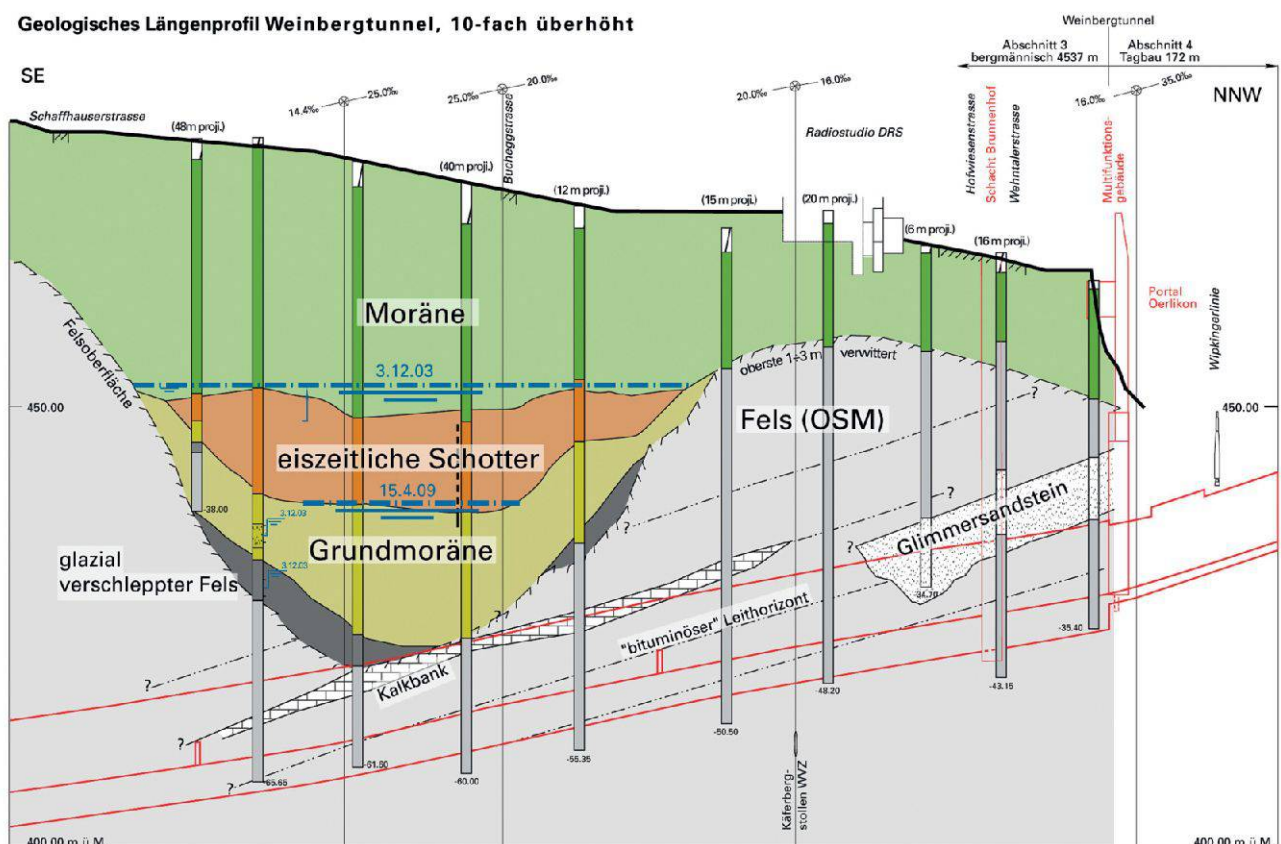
Durchmesserlinie Zürich, Weinbergtunnel: Geologisches Längensprofil Portal Oerlikon – Felsdepression Buchegg – Schaffhauserstrasse mit Darstellung Grundwasserabsenkung (Geologie: Projektstand Ausschreibungsunterlagen), 10-fach überhöht.
